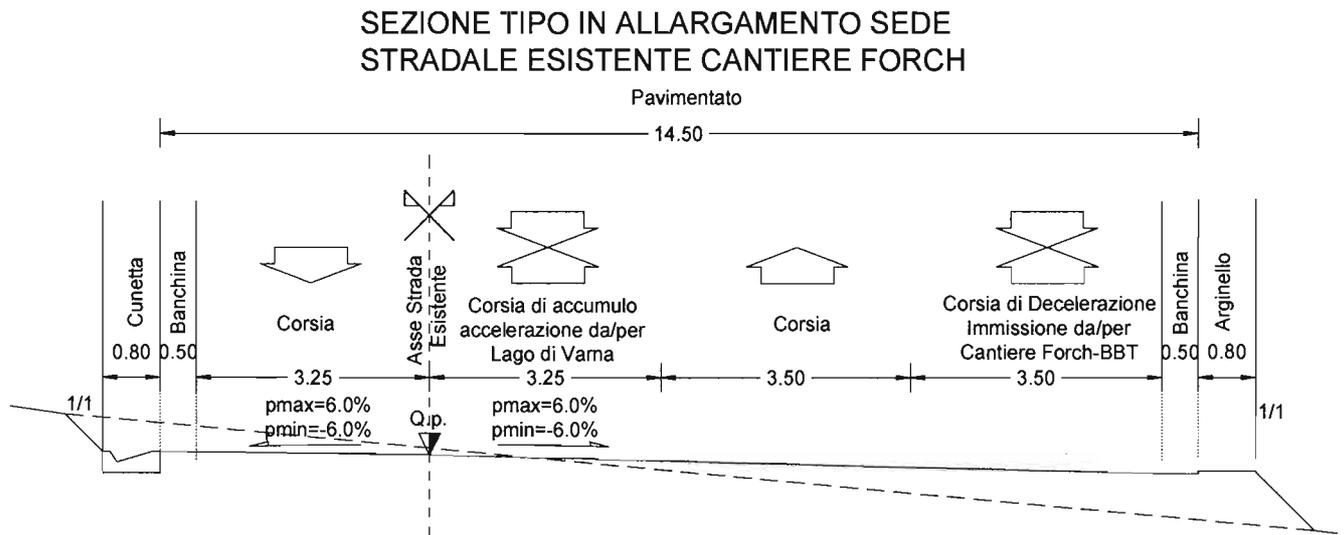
Sezione Tipo Strada Statale Allargamento Svincolo Forch
